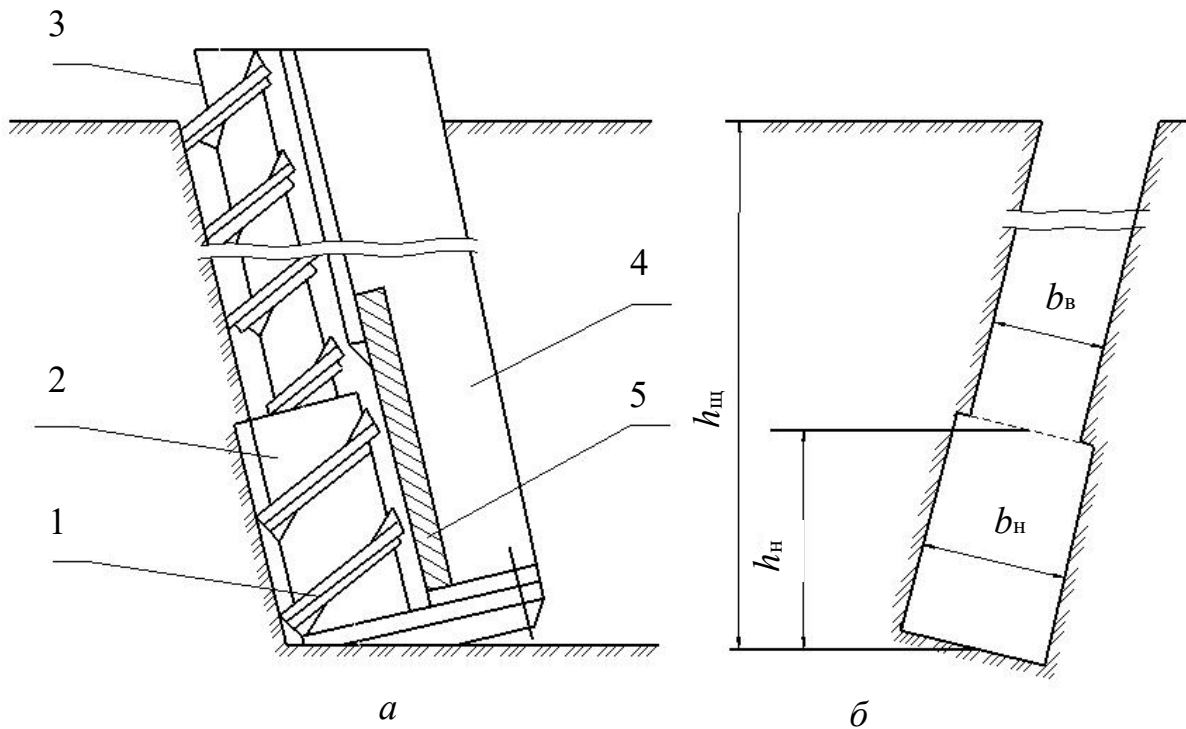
Схема винтовой фрезы (а) и сечение щели (б):
